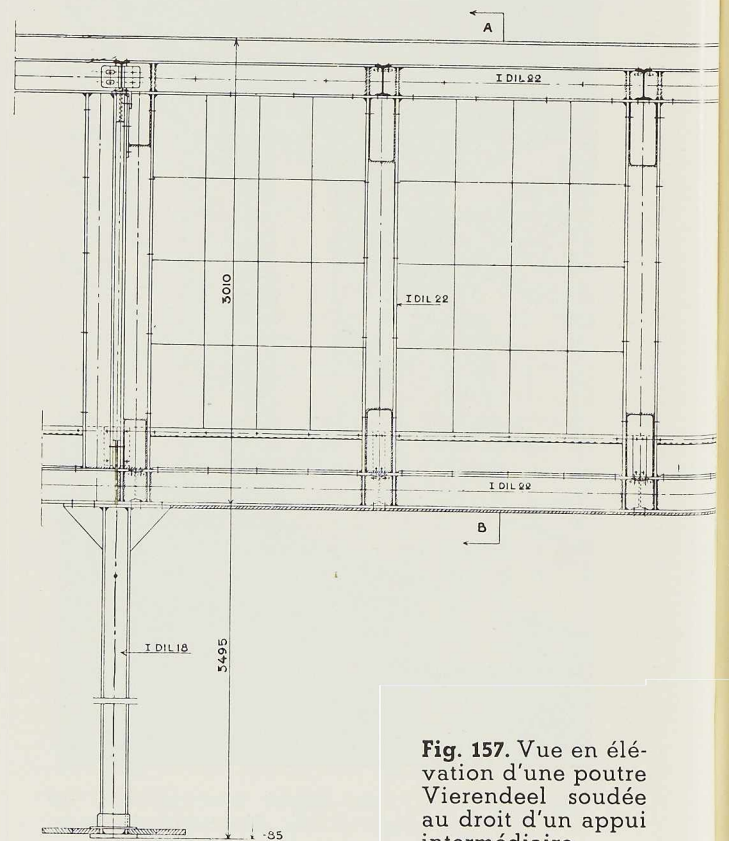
Vue en élévation d'une poutre Vierendeel soudée au droit d'un appui intermédiaire.
